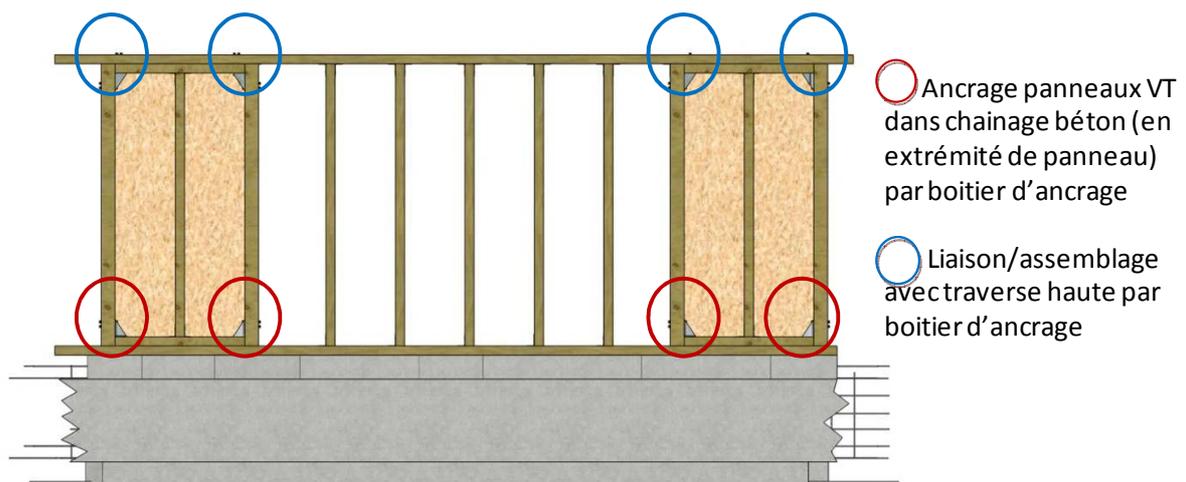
Schéma de principe de la mise en place et de l'ancrage de voiles travaillant pour une maison à simple RdC
